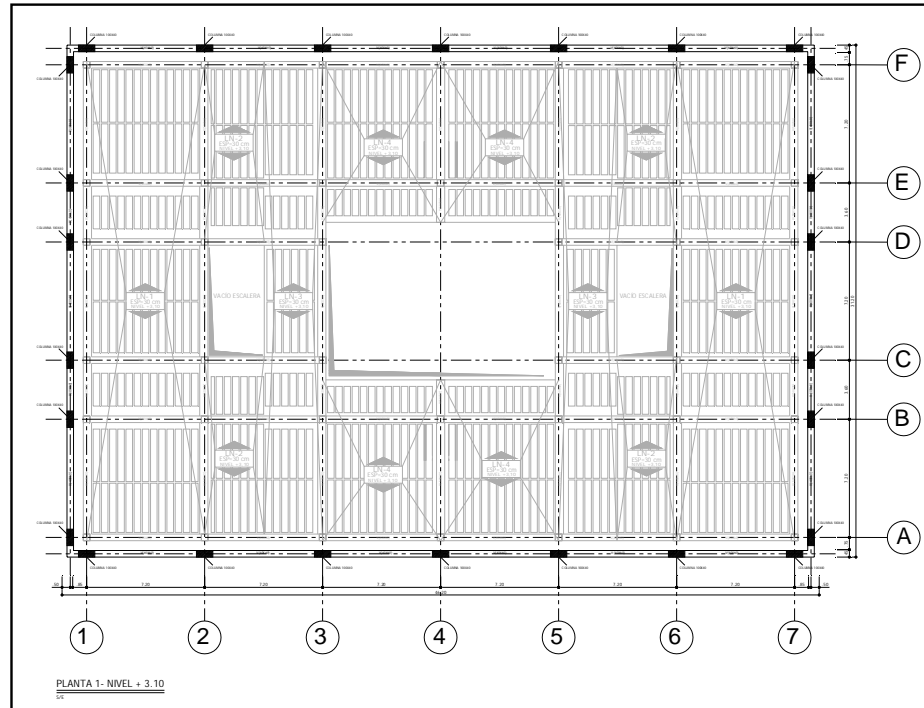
Planta tipo del modelo de refuerzo de muros aporricados.
